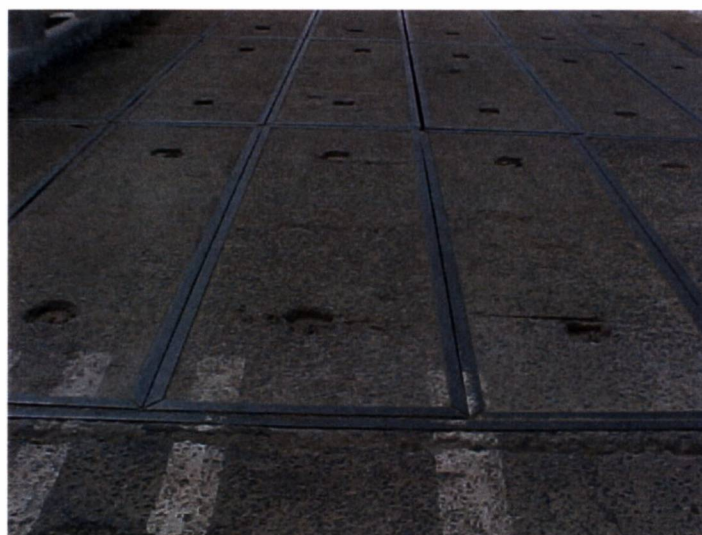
VISTA FRONTAL DA PONTE 8
